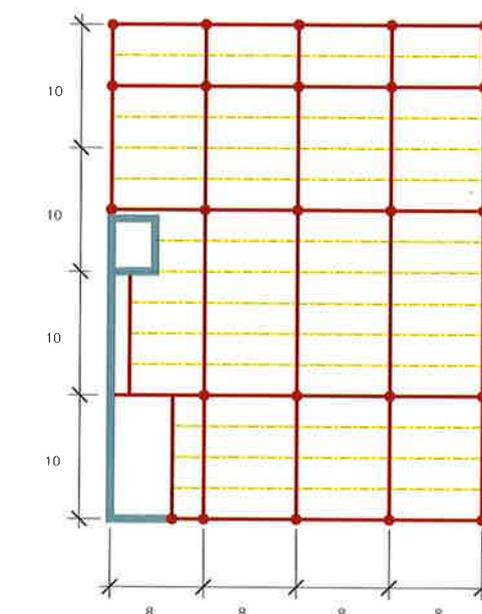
Exemple, plancher intermédiaire R 60: dalle mixte avec champs membranaires (vue en plan); seuls les poteaux et les poutres en rouge sont protégés contre le feu.
